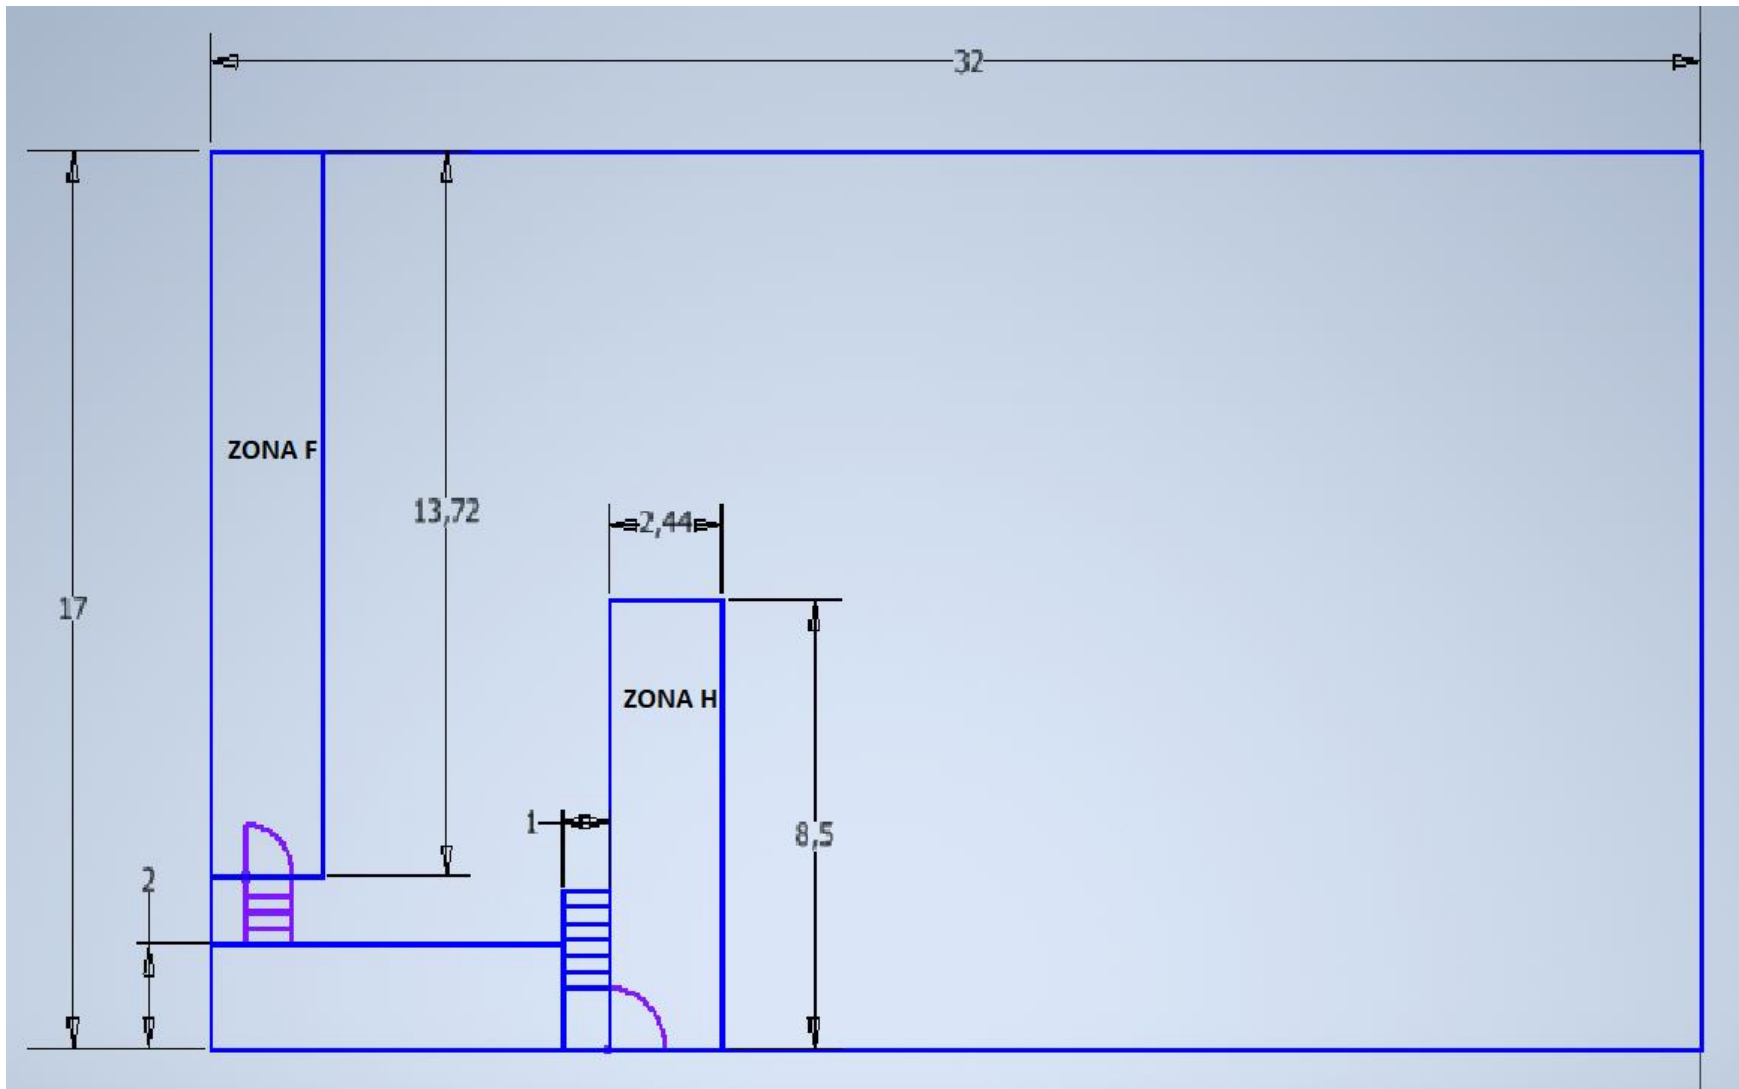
Diseño del Tecnocentro Planta alta Fuente: Autores.
